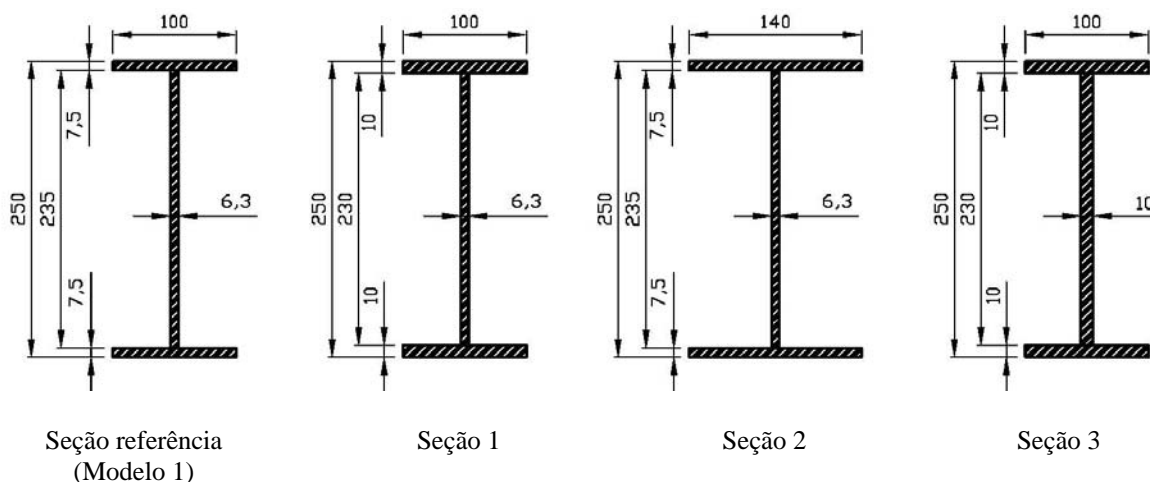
Seções transversais das vigas utilizadas na análise paramétrica.
